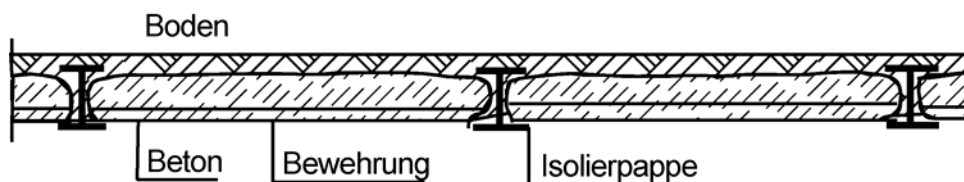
Trägerbohlwand mit Ortbetonausfachung [5]
